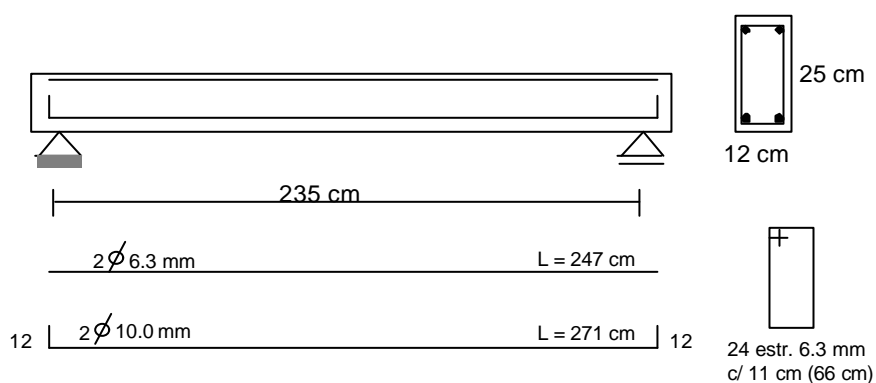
Armadura da viga reforçada com chapa de aço
